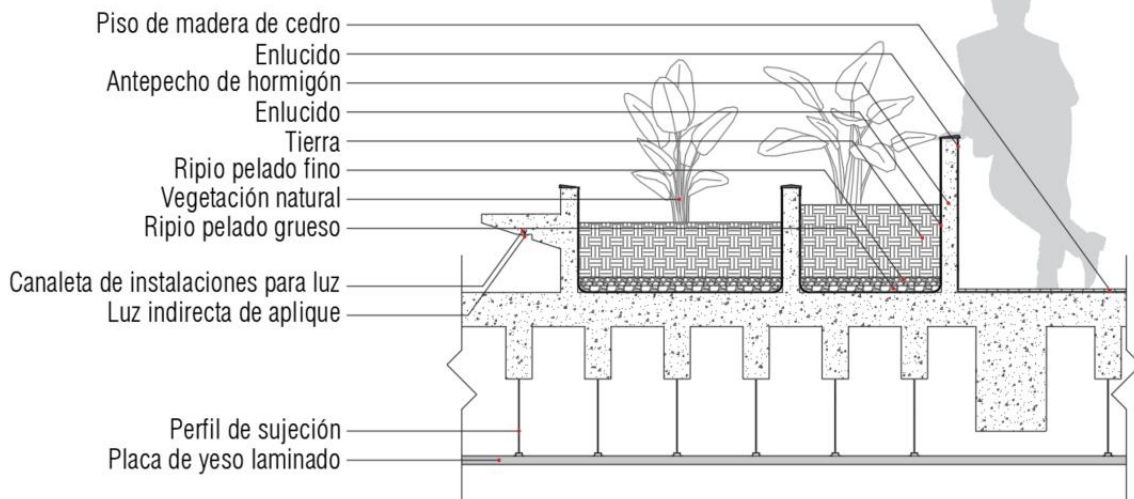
Detalle A3 - Proyecto definitivo. Elaboración propia.
